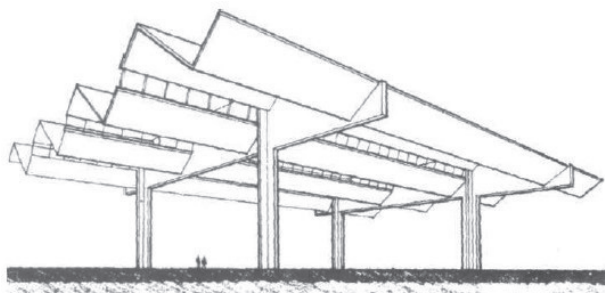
Estudio de cubiertas industriales de lámina con una sección en Z de Félix Candela, 1947.
